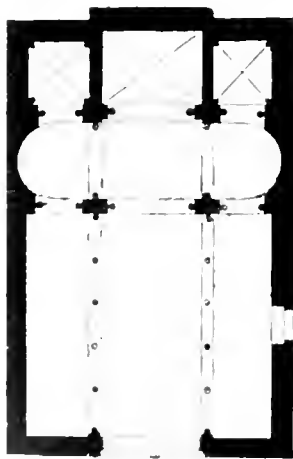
San Cebrian de Mazote. Planta reconstruïda. (Agapito y Revilla)
